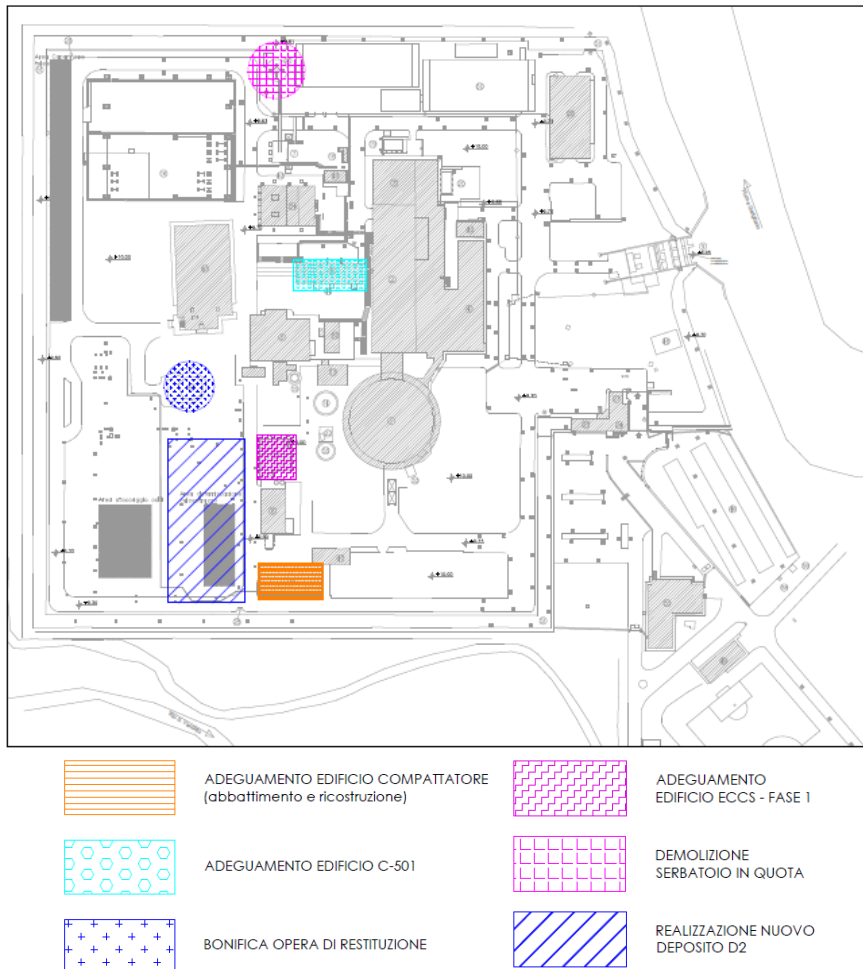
Primo semestre 2023 - rappresentazione spaziale delle interferenze dei cantieri
